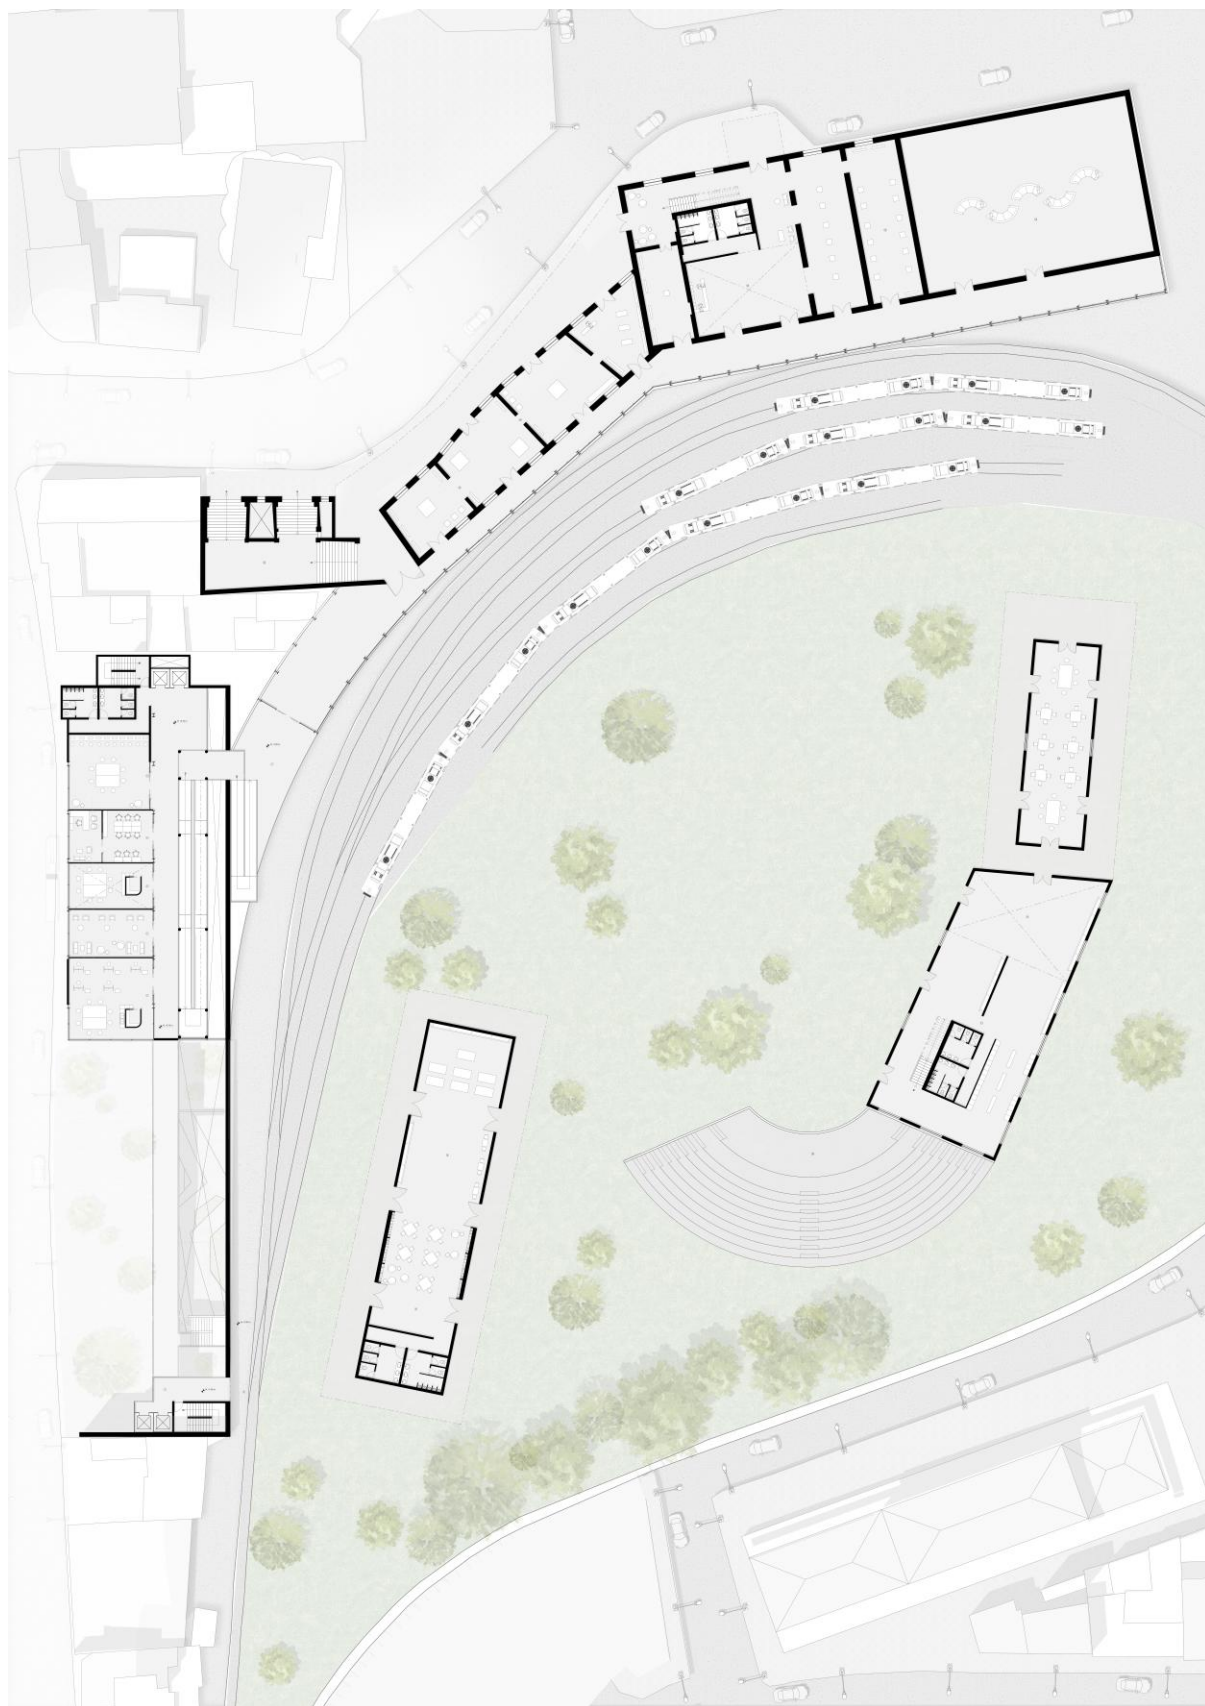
Planta Baja N+1.5m. Elaboración propia
